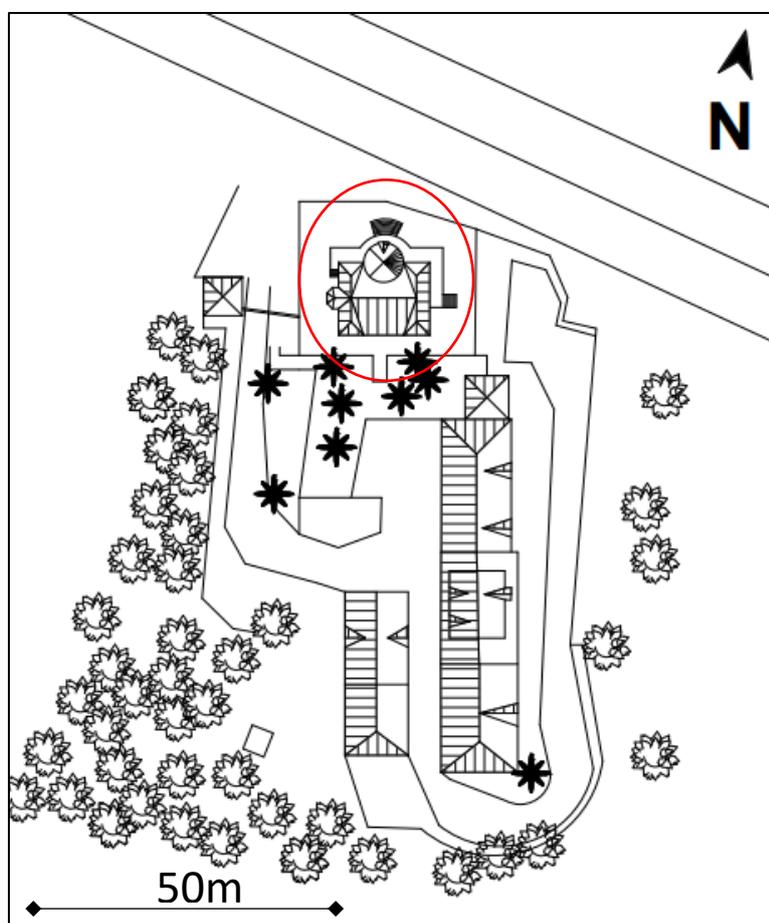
Plan de masse du Château Poizat. Source : Auteur. 2023
